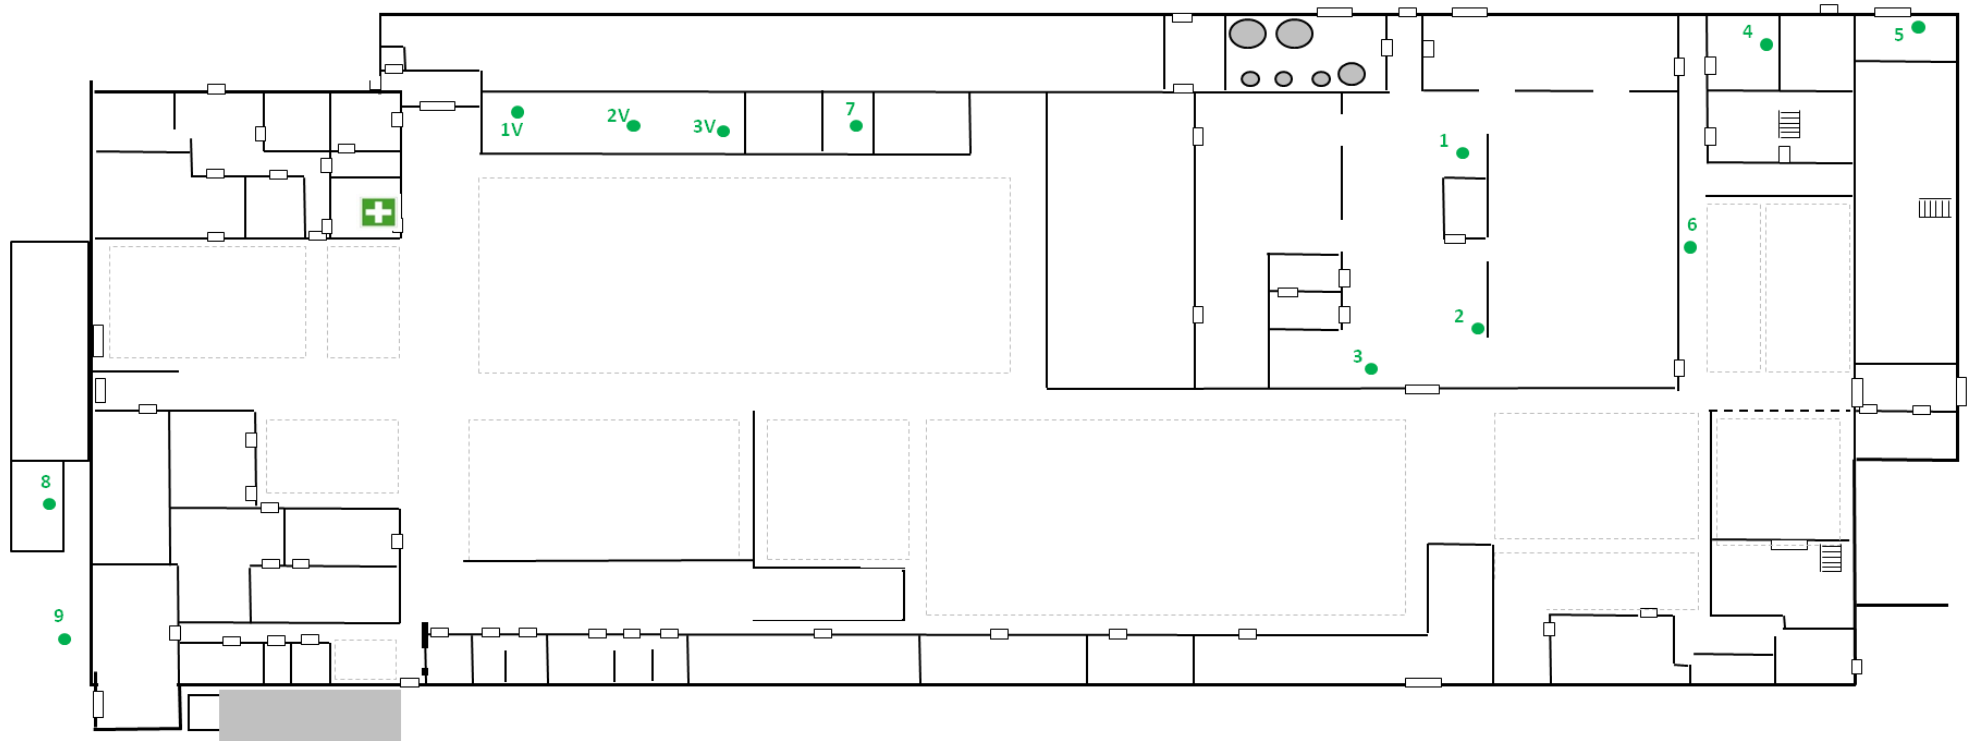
Localisation des investigations d'air sous la dalle béton mises en œuvre en février/mars 2017 (fond de plan MECABRIVE)
